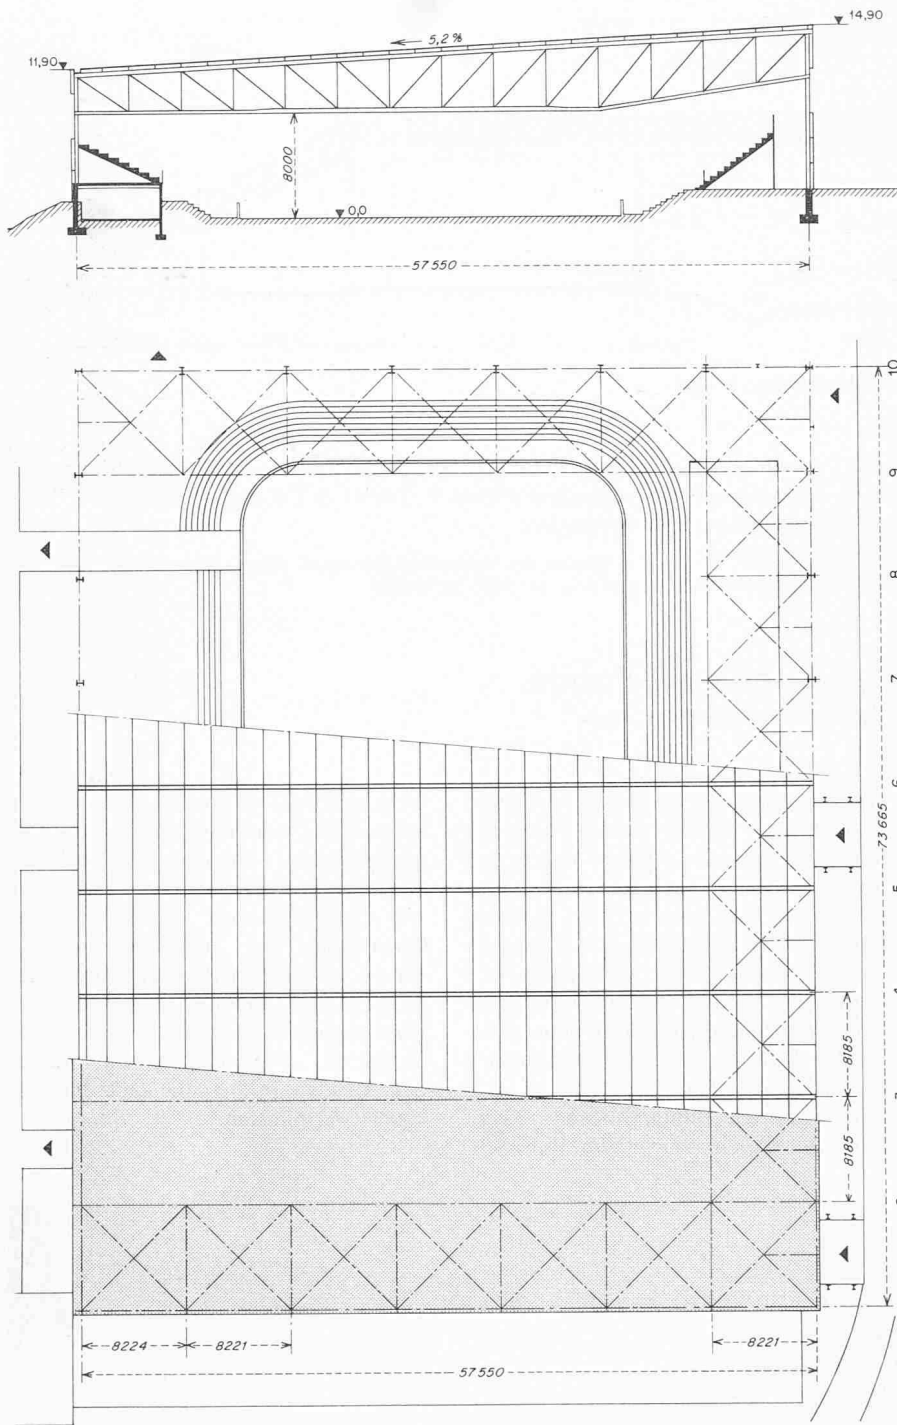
Eisstadion-Überdachung in La Chaux-de-Fonds, Querschnitt und Grundriss 1:600
